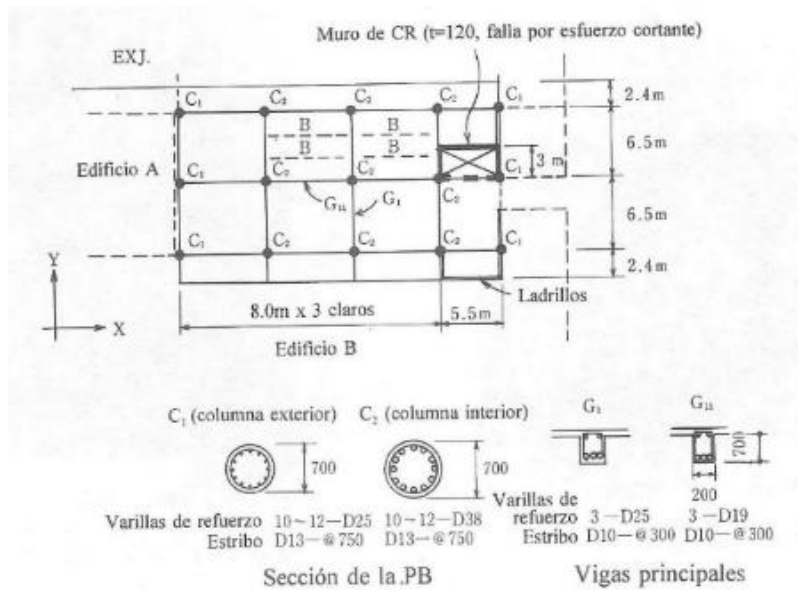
Planta tipo del edificio 246 (Masaki et al., 1996)
